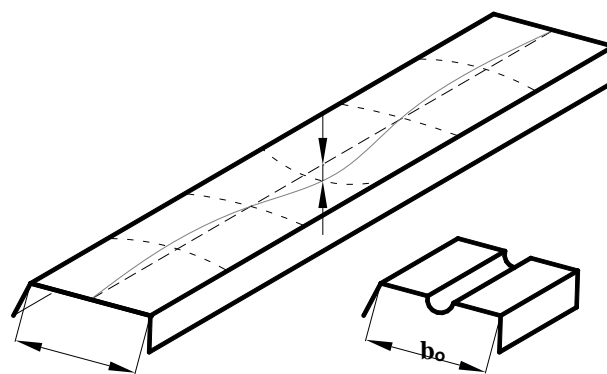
Planéité des plages/sommets ou âmes raidis ou non raidis
